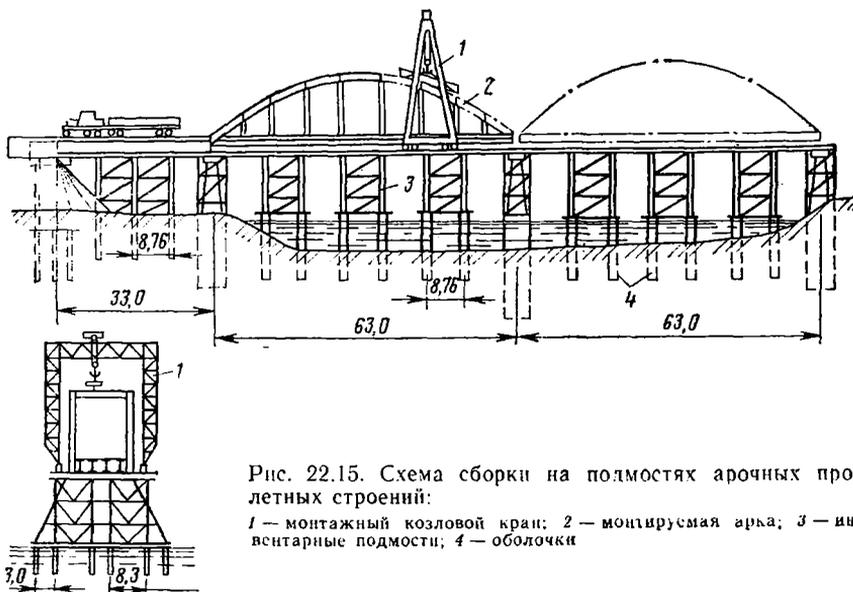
Схема сборки на подмостях арочных пролетных строений:
